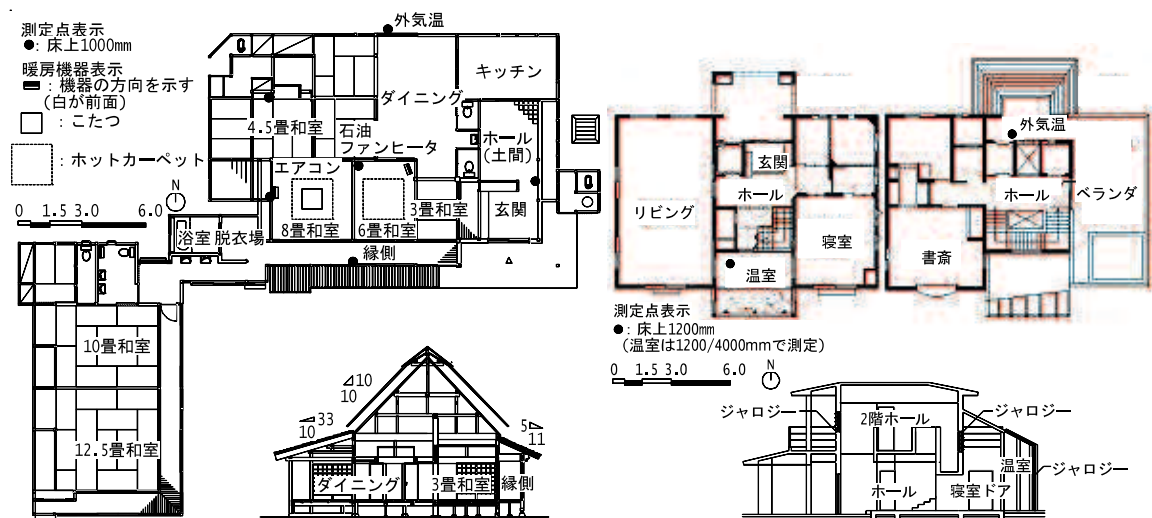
伝統民家の平面・断面図と計測点 図 3.2 温室付設住宅の平面・断面図と計測点
